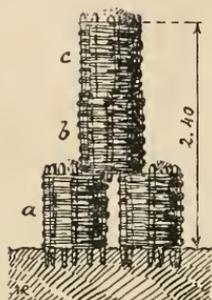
Coupe en élévation et plan d'une paroi verticale en gabions.
